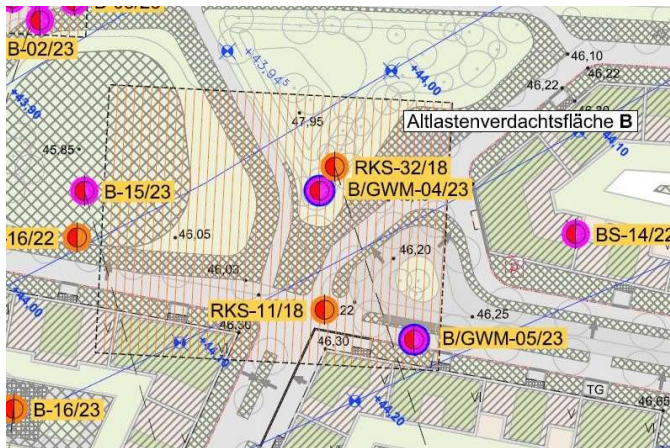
Ausschnitt Altlastenverdachtsfläche B, Bodenbelastungen im Bereich geplanter Versickerungsanlagen [A10]
